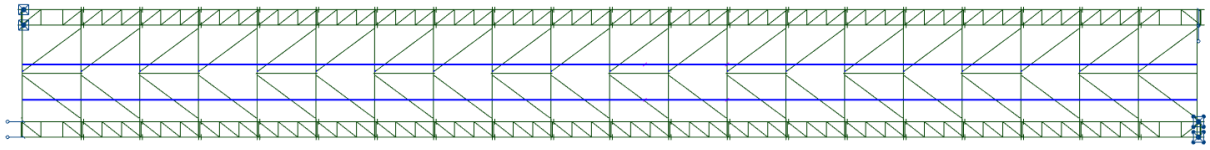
Planta da ponte com os “carris” realçados a azul
